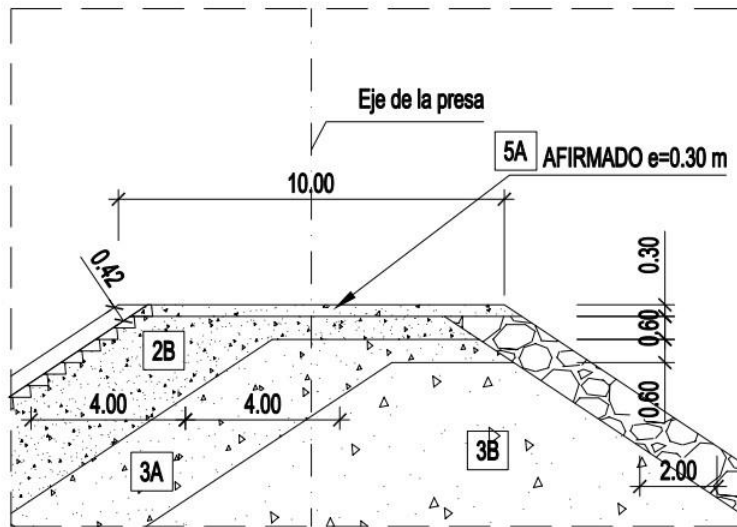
Detalle A de la presa. Fuente: Elaboración propia
